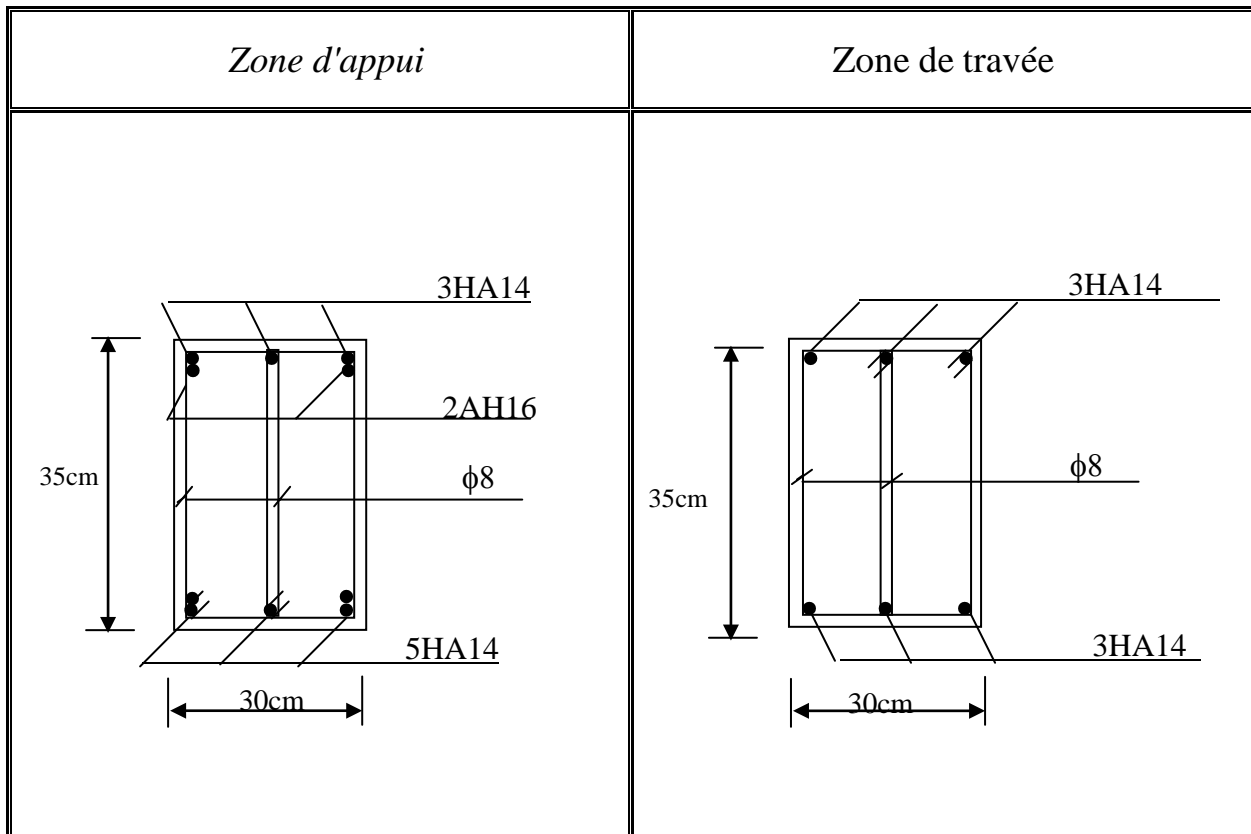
Croquis de ferrailages des poutres secondaires.
